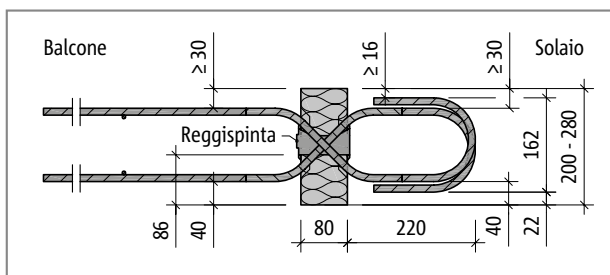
Schöck Isokorb® tipo Q40M-VV – Q60M-VV, QP40M-VV e QP60M-VV: sezione dell'elemento
